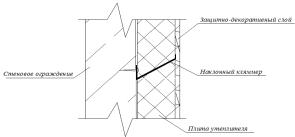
Устройство утеплителя с горизонтальным стыком наклонным к стене, кляммер тоже выполняется наклонный [7]
